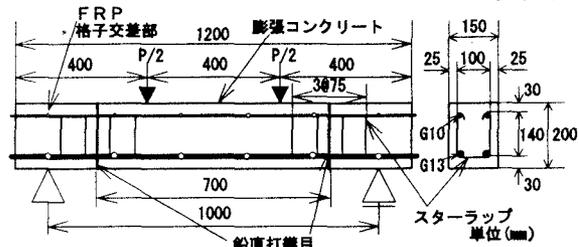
はり供試体の断面形状寸法と載荷方法(格子間隔20cm)
